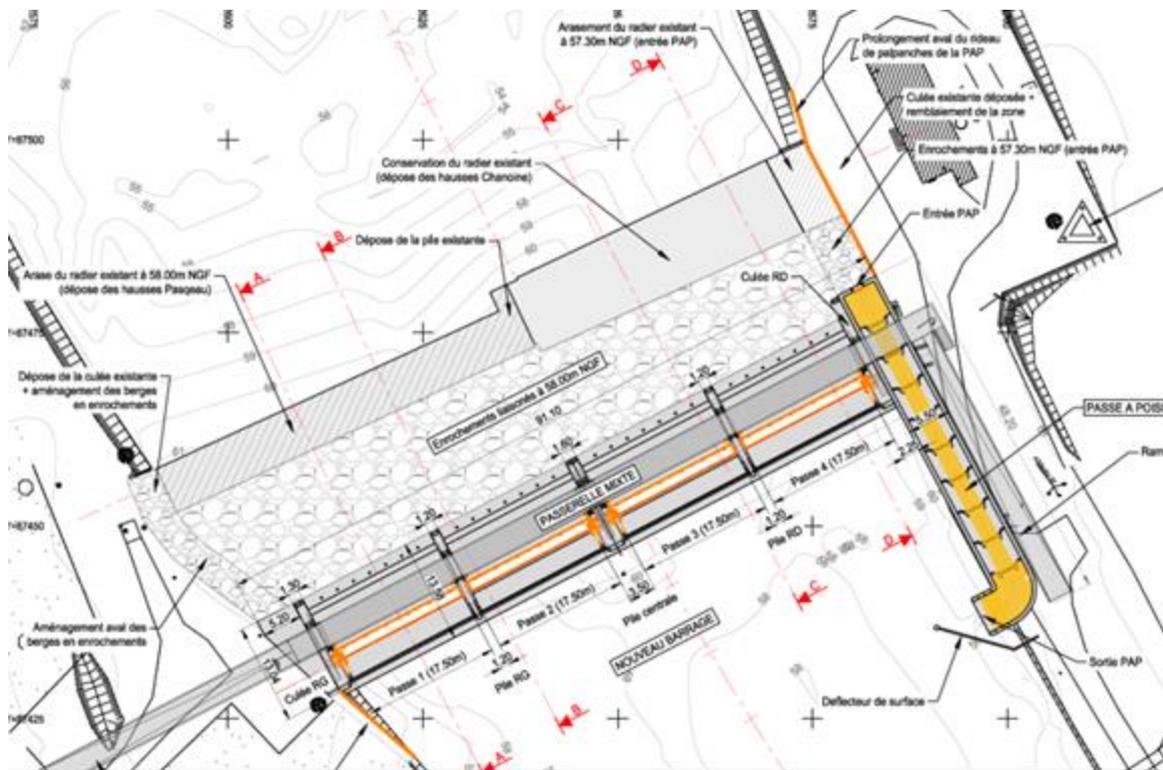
Plan de masse projeté (barrage et passe à poissons)
